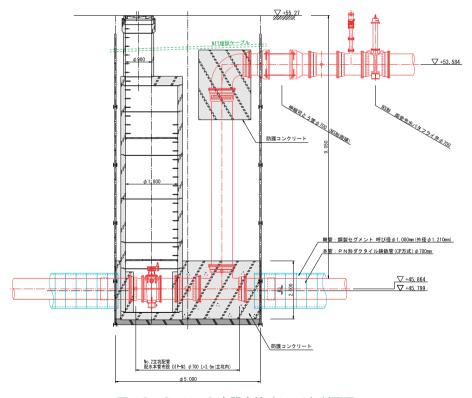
2 No.2 中間立坑 (A - A) 断面図
